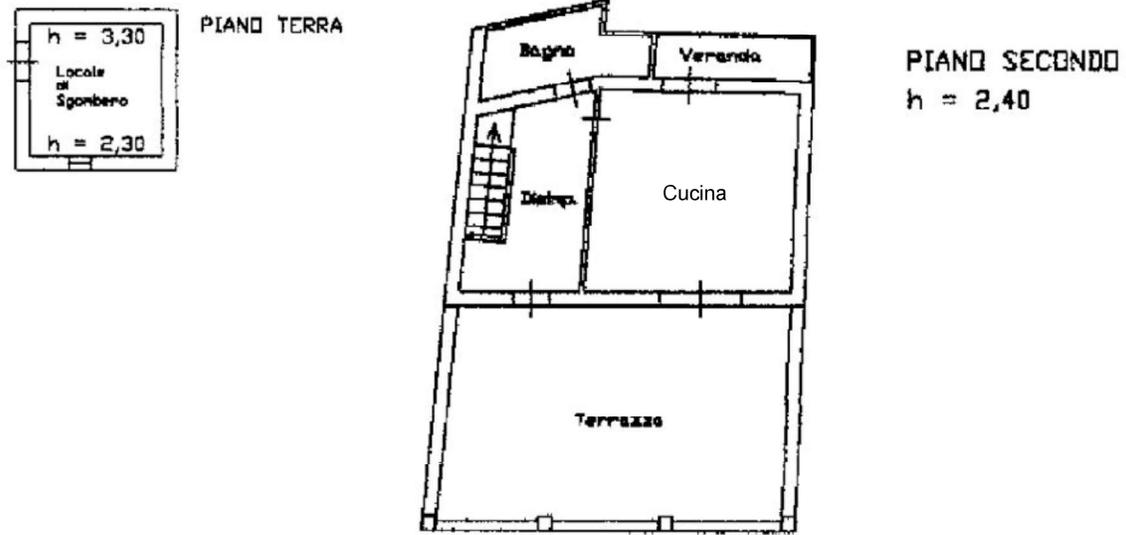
Pianta dei piani dell'alloggio con destinazione d'uso dei vani
